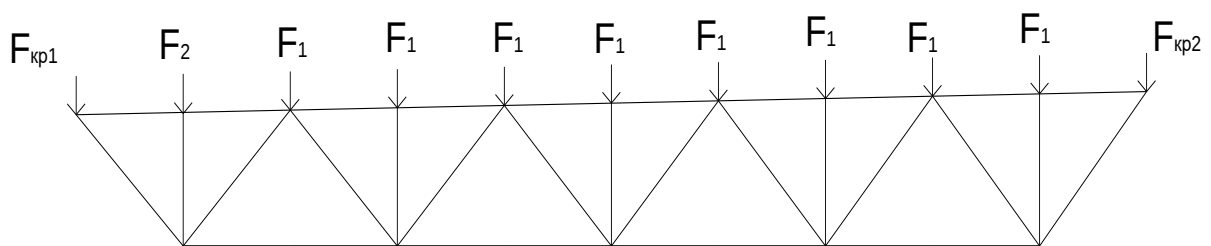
Схема прикладання навантажень до кроквяної ферми
